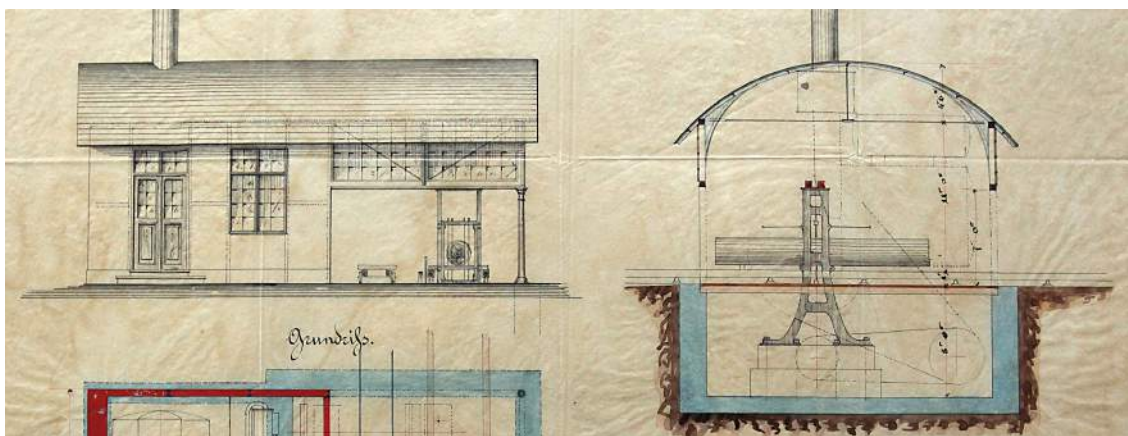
Ausschnitt der Planung des Vorgängerbaues im Jahr 1880 mit Dampfmaschine im UG
